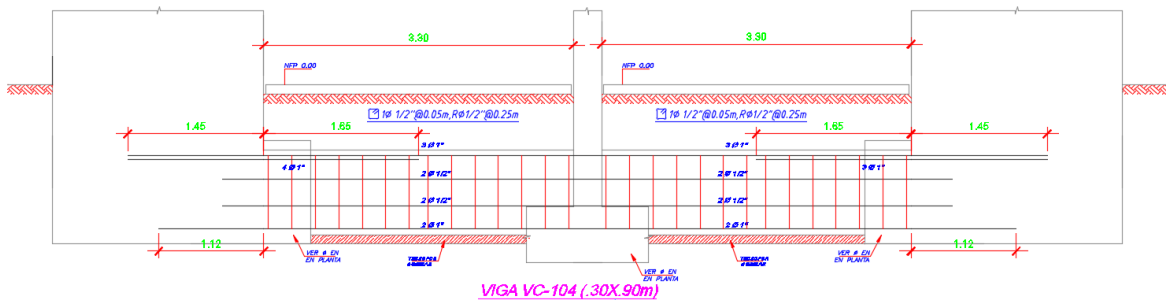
diseño final de la viga de cimentación VC-104.
